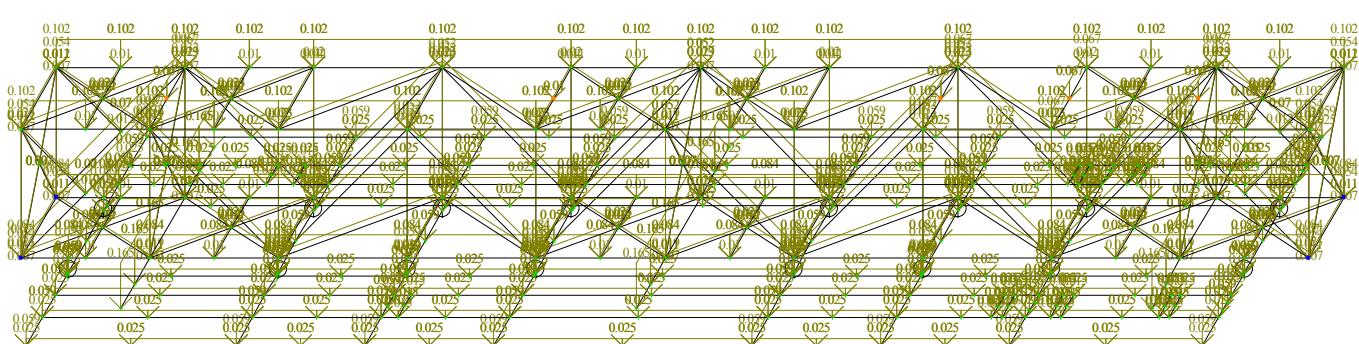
Вертикальные нагрузки от собственного веса конструкций ферм
